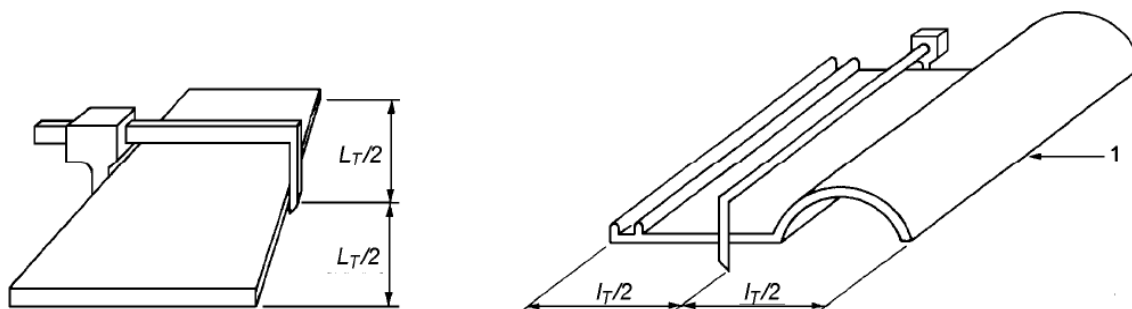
Dimensões de sobreposição (telhas canudo)
